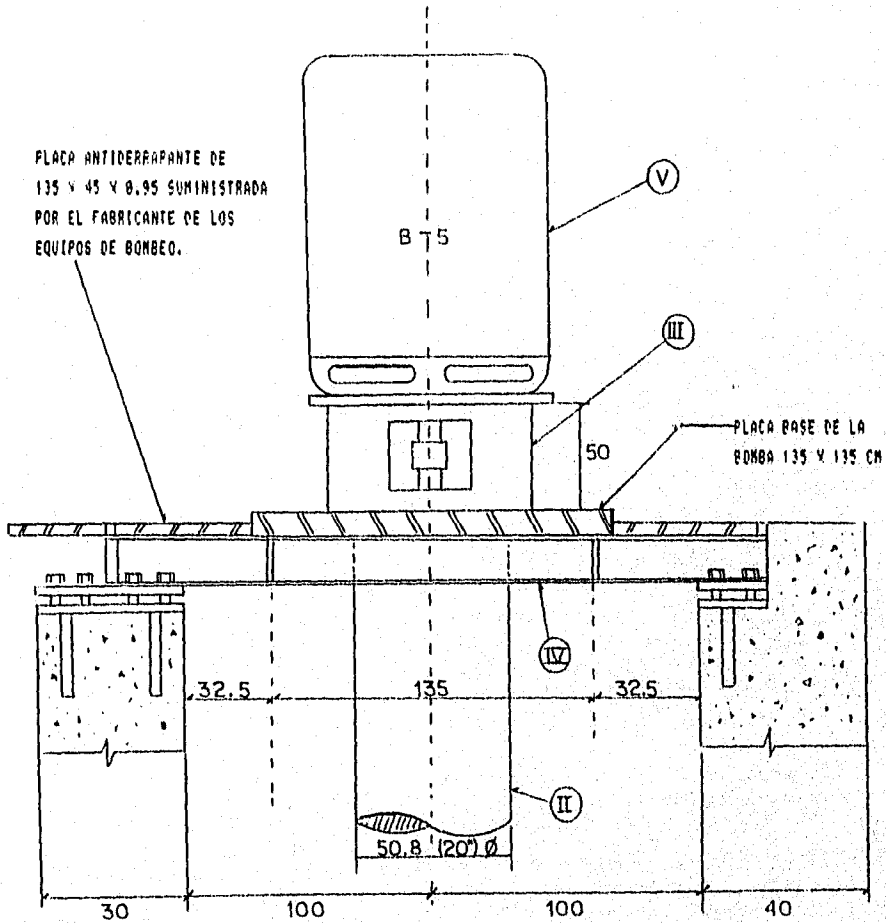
VIGAS SOPORTE DEL GRUPO MOTOR BOMBA.
